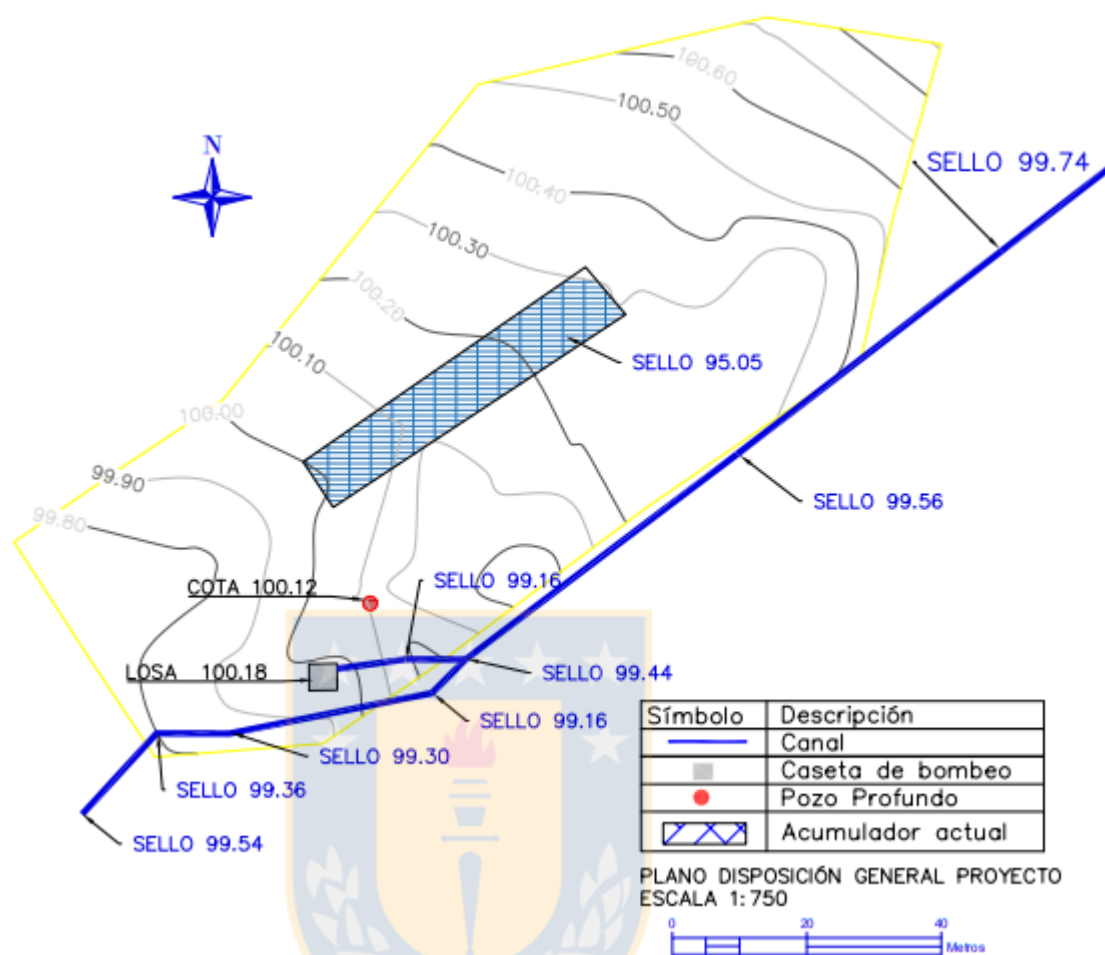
Plano de disposición general en terreno del canal de riego, acumulador existente y caseta de riego. Fuente: Elaboración propia.
